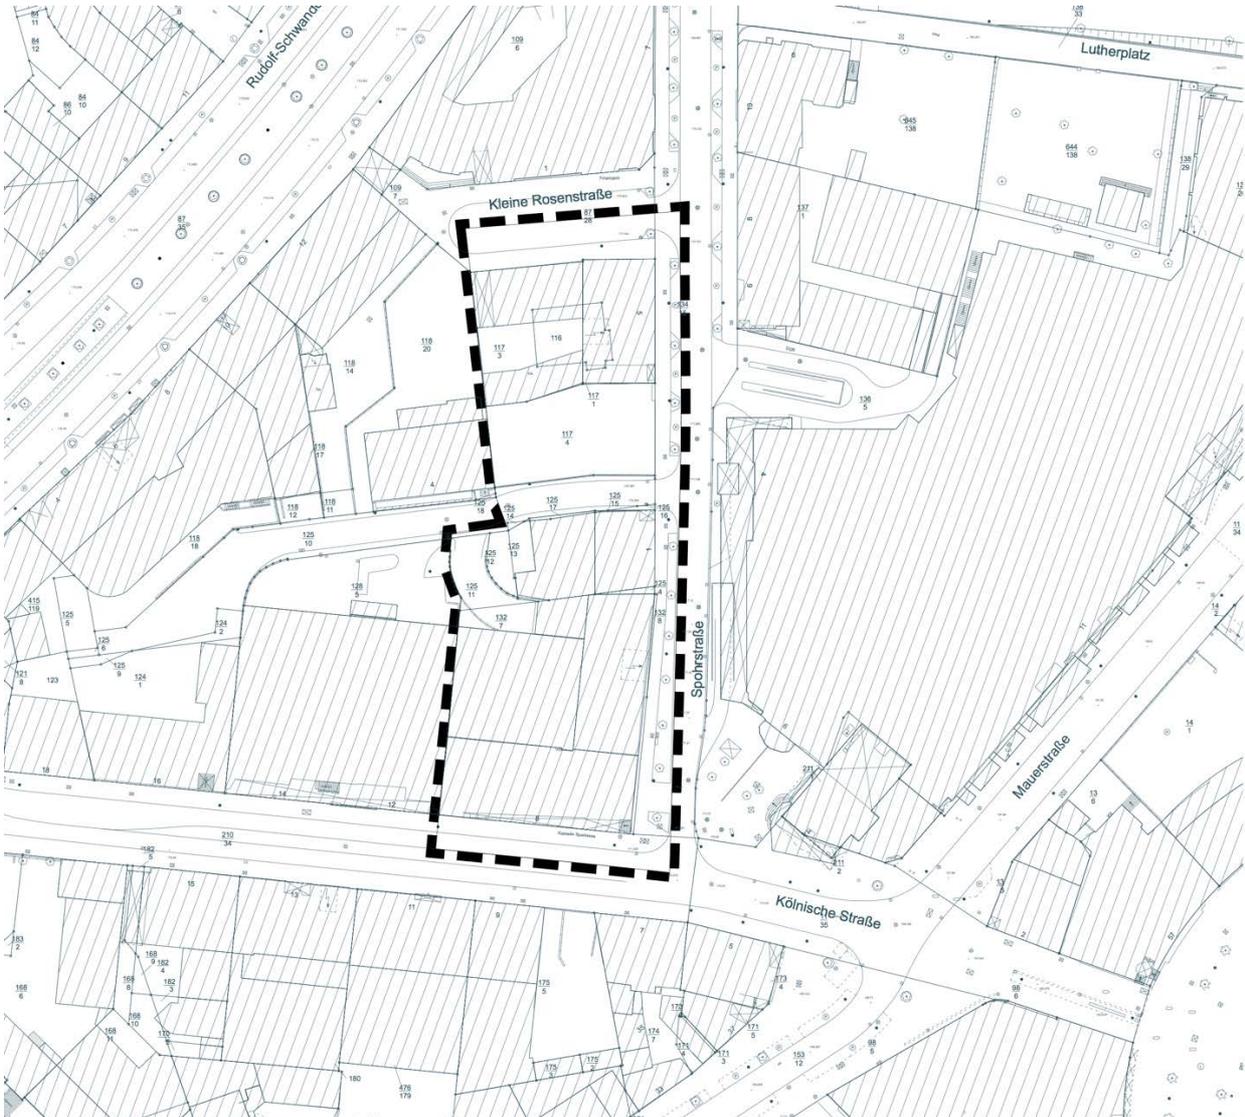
Lageplan mit Darstellung des Geltungsbereichs (Kartengrundlage: Stadt Kassel – Vermessung und Geoinformation)
